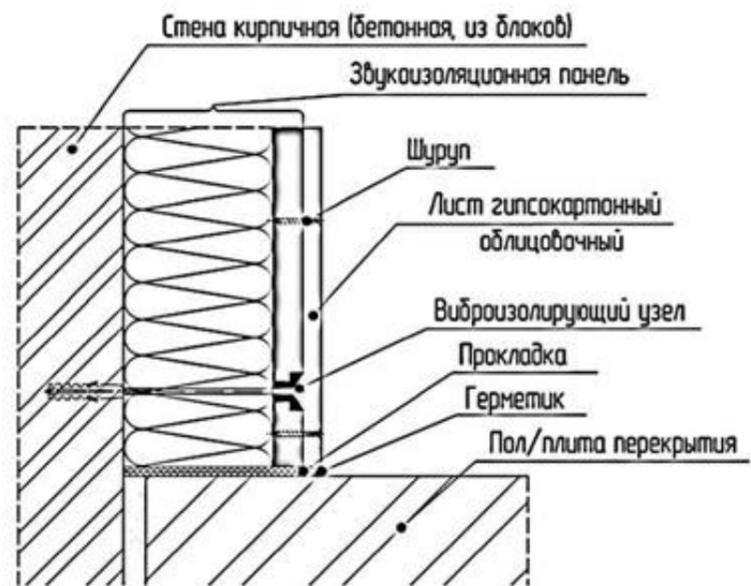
Примыкание бескаркасной облицовки к полу/плите перекрытия
